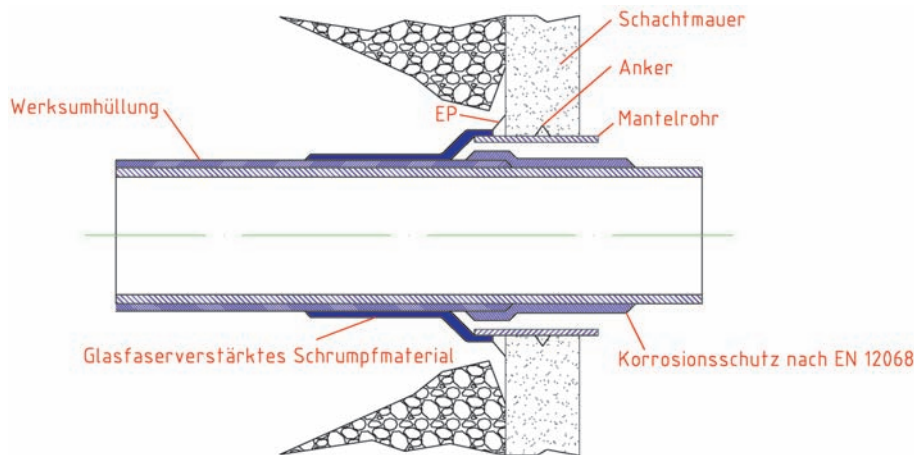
Beschichtung im Bereich einer Rohrdurchführung mit Abdichtung
